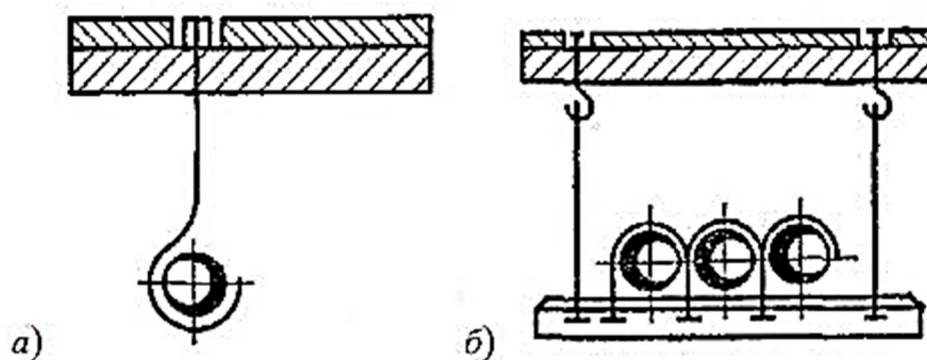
Схема крепления трубопровода на подвесках: а – на одной тяге; б – на двух тягах
